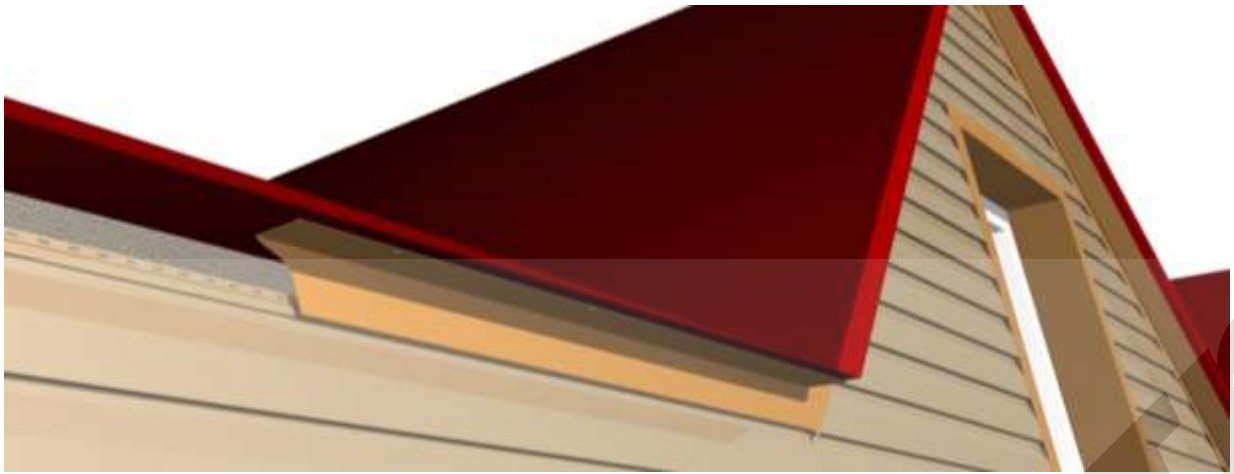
Завершение сайдинга, стыковка с кровлей, кровлей с использованием планки угла внутреннего.
